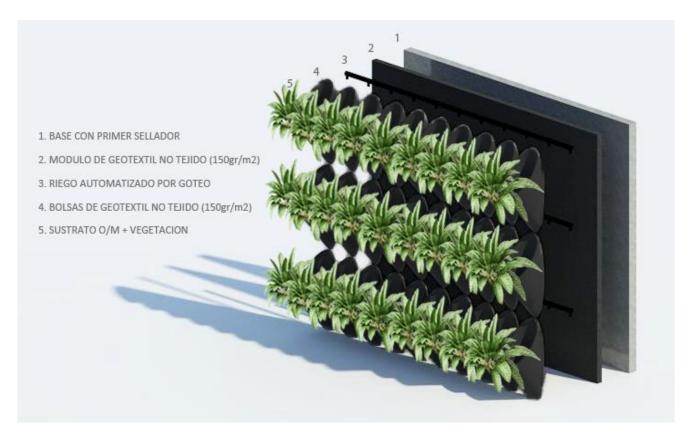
Detalle constructivo de jardín vertical Fuente: Césped Ecuador (2020)
